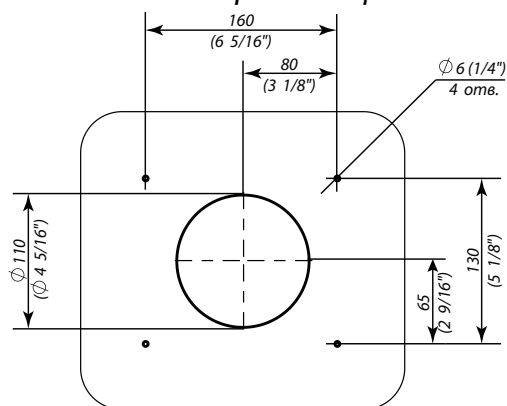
Схема разметки отверстий под крепеж наружных боксов
